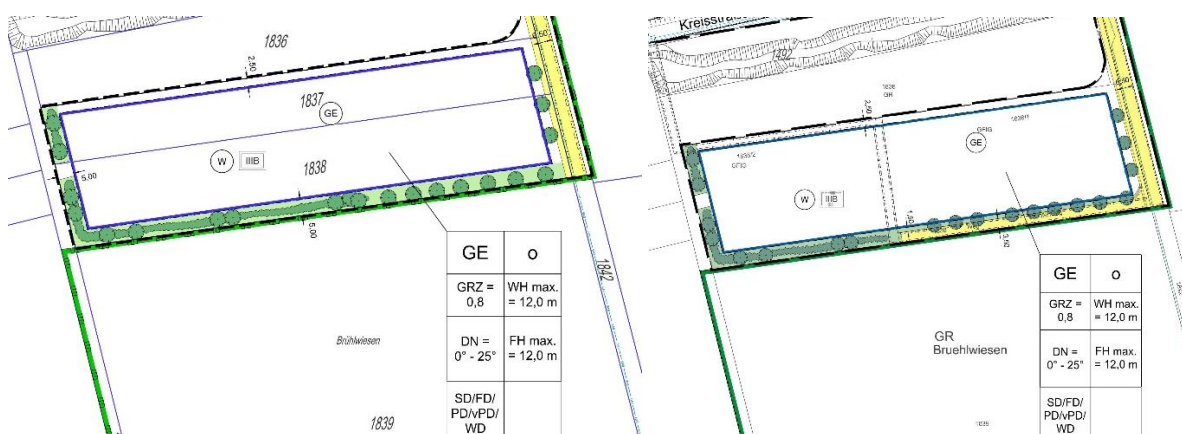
Ausschnitt der Bebauungspläne Brühlwiesen (links) und 1. Änderung des Bebauungsplanes Brühlwiesen (rechts)
